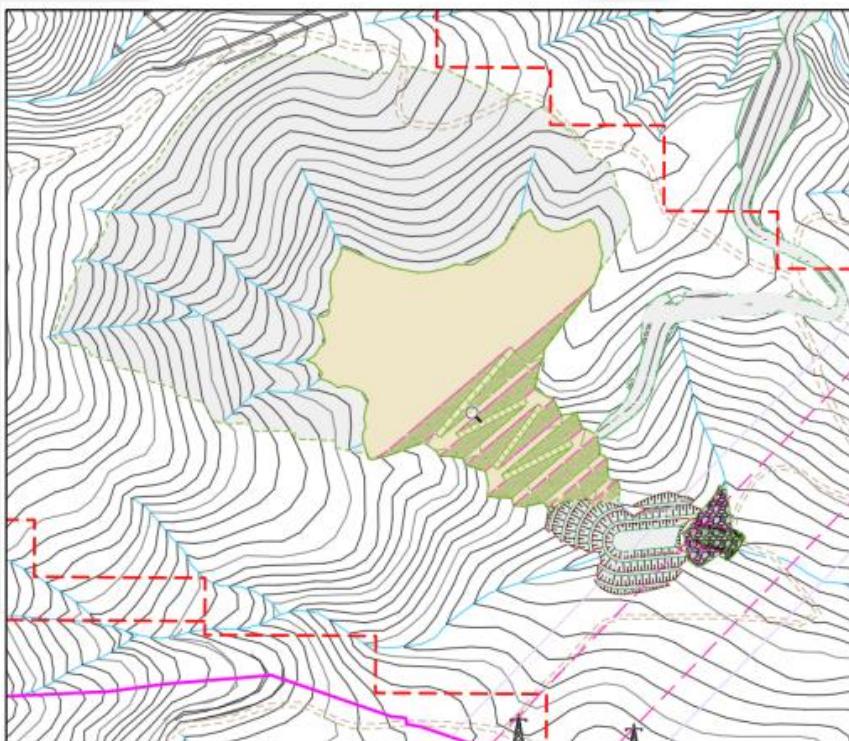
ARRANJO GERAL DA PDE-1 FASE 1. FONTE: PROJETO DA PILHA DE ESTÉRIL 1 –SSX.
